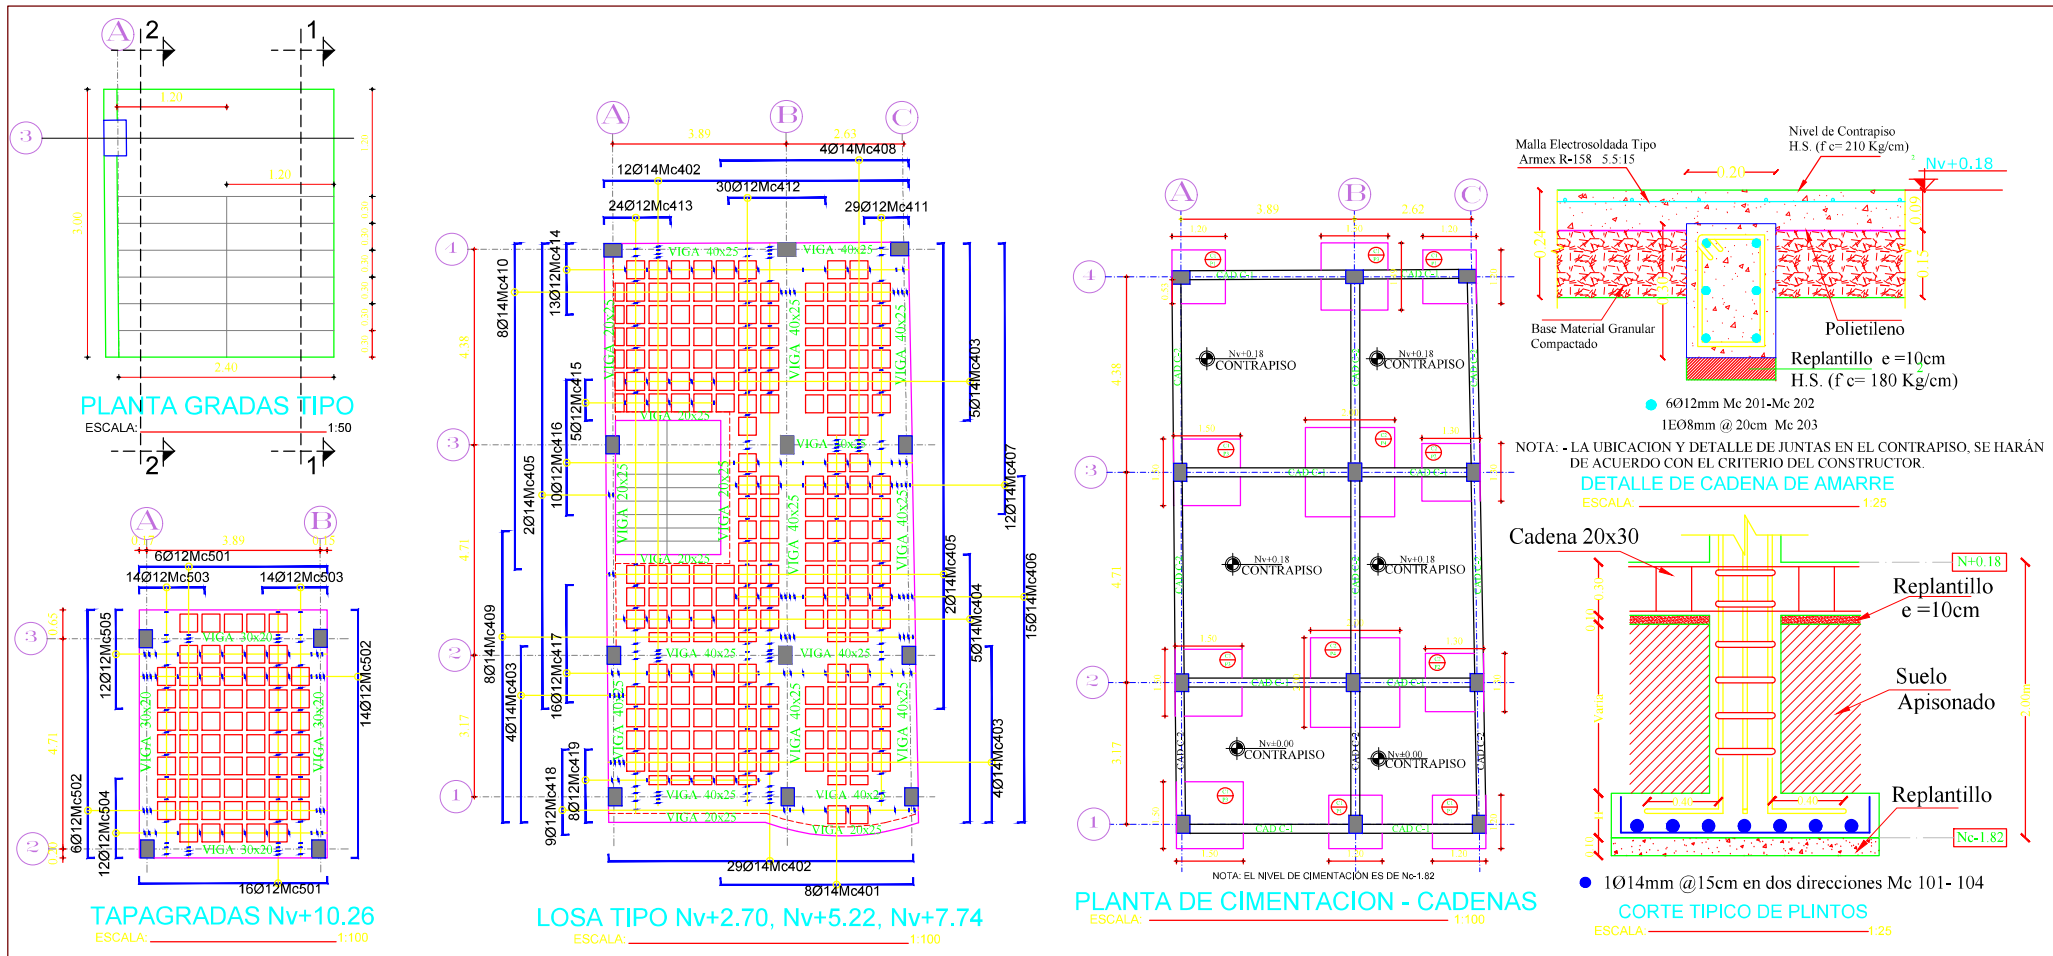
Sistema de pisos estructurales en hormigón armado del proyecto base.
